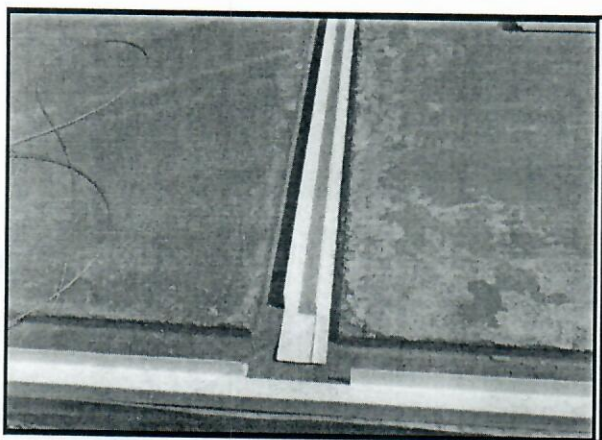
Perfil em PVC para fixação parede com a fundação.
